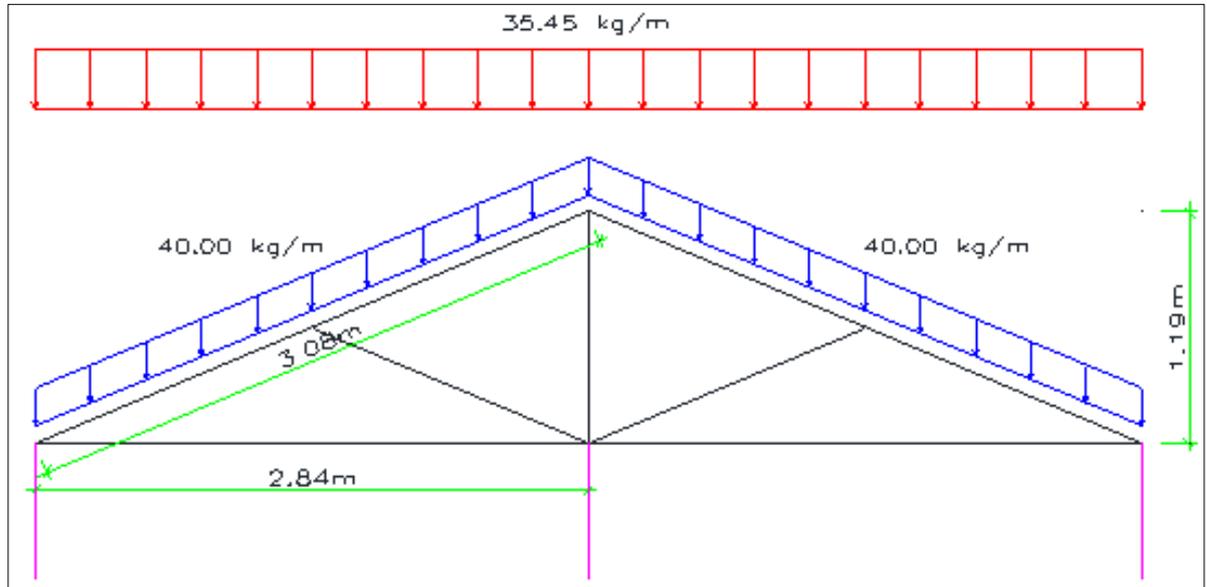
Esquema de la distribución de cargas de la cobertura de techo a dos aguas hacia las columnas
